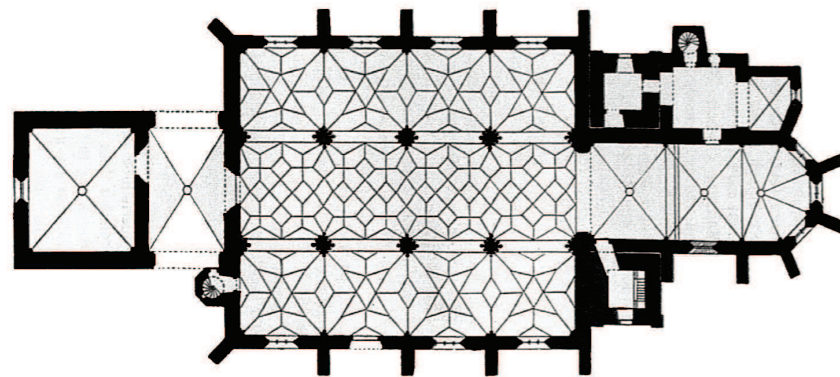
Grundriss der Pfarrkirche St. Stephan
